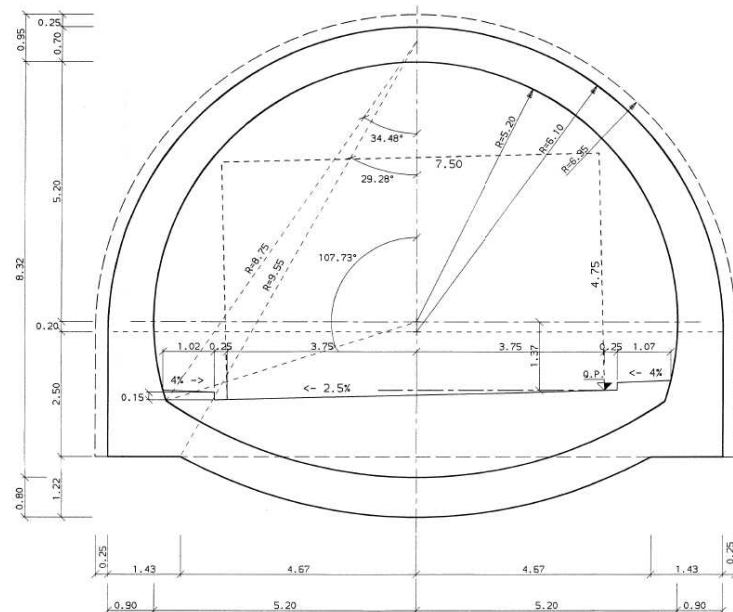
PE GEODATA 1996 – Galleria Guinza - Sezioni Tipo E – Carpenteria
